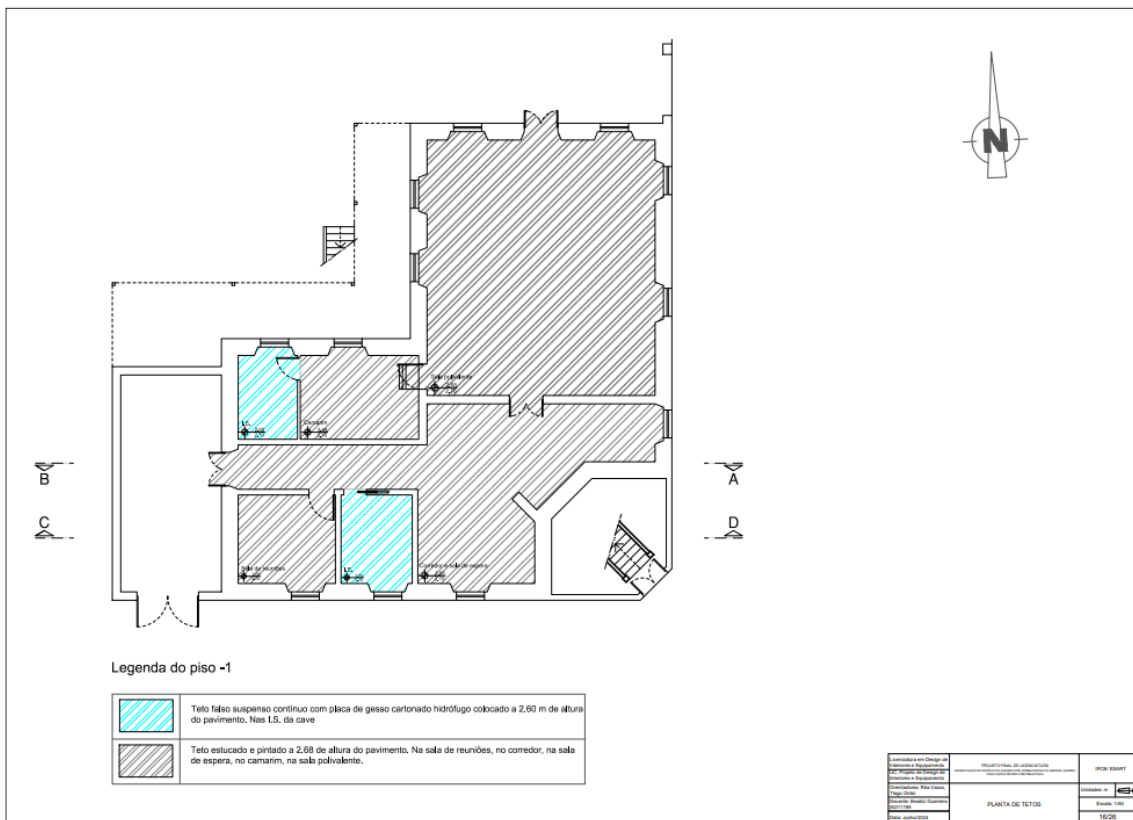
Planta de Tetos, piso 0, sem escala. Fonte: Autor
